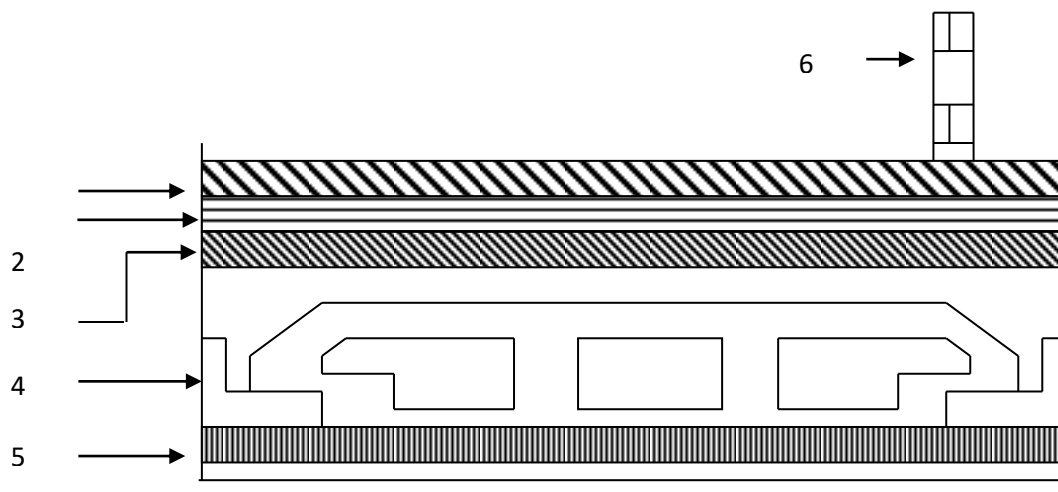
Plancher corps creux (terrasse accessible)
